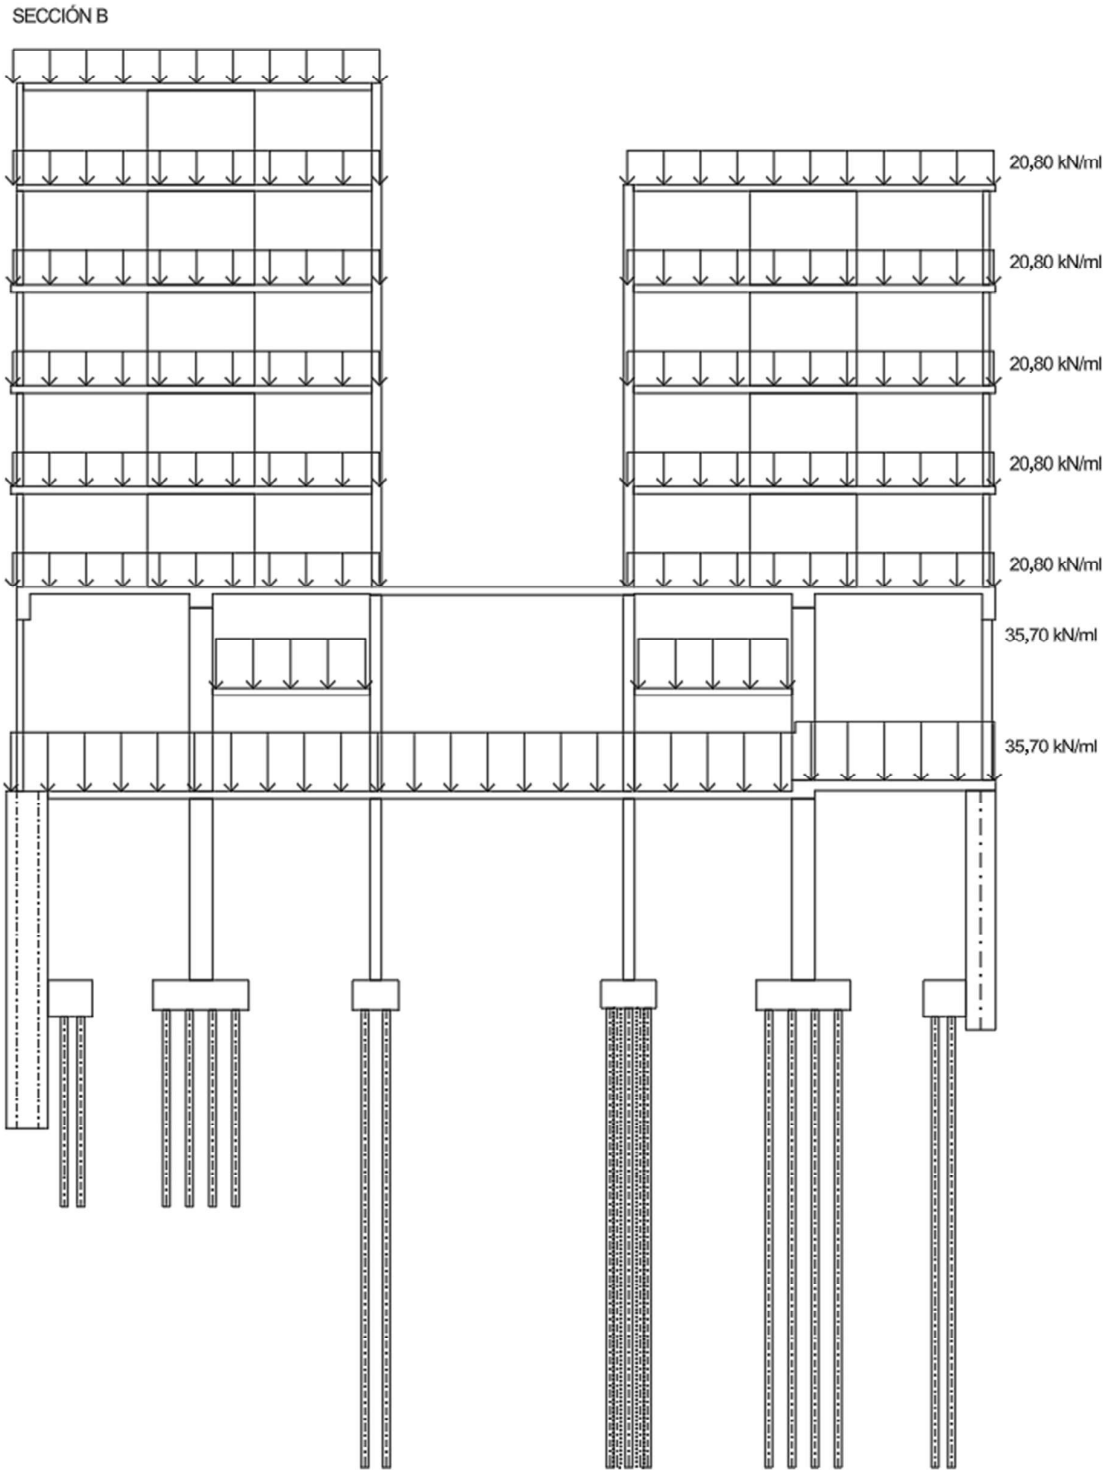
Cargas aplicadas en los pórticos analizados – Sección B (estado inicial y estado de proyecto)
